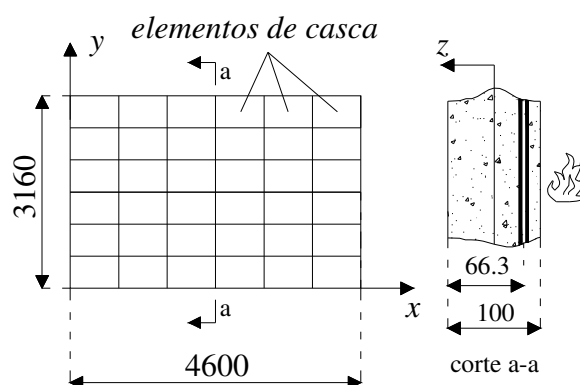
Geometria e discretização da laje. Dimensões em mm.
